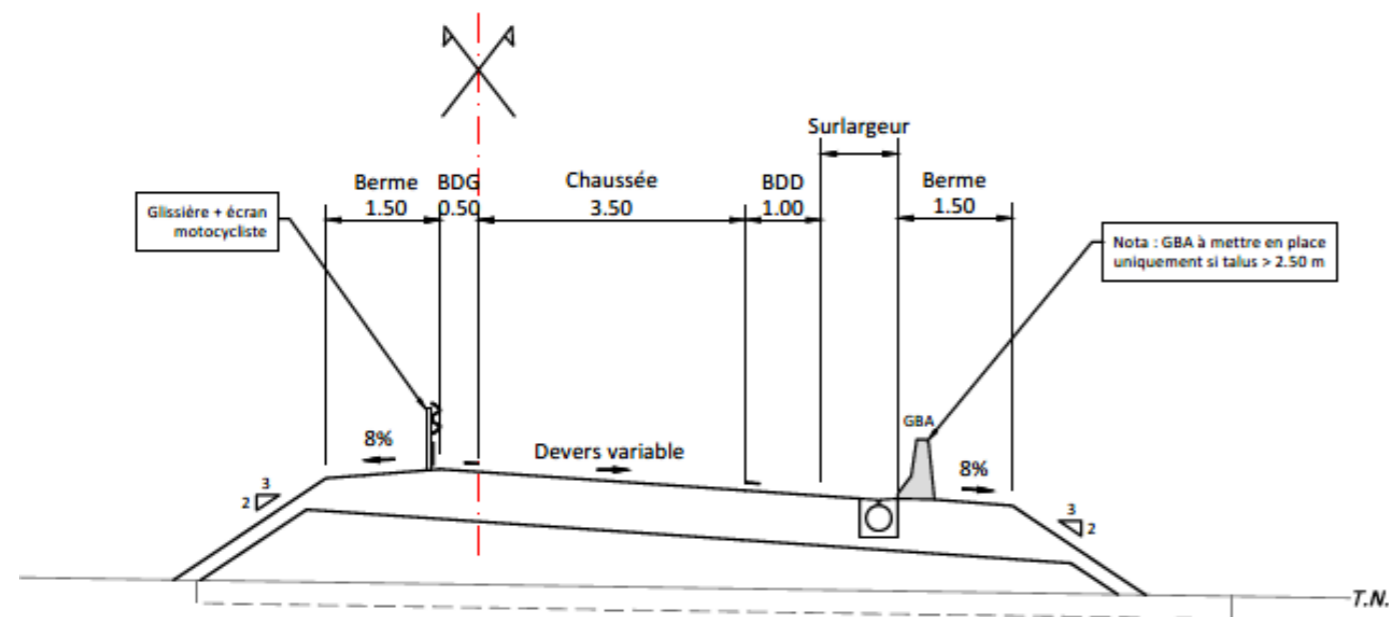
Profil en travers type – bretelle unidirectionnelle
